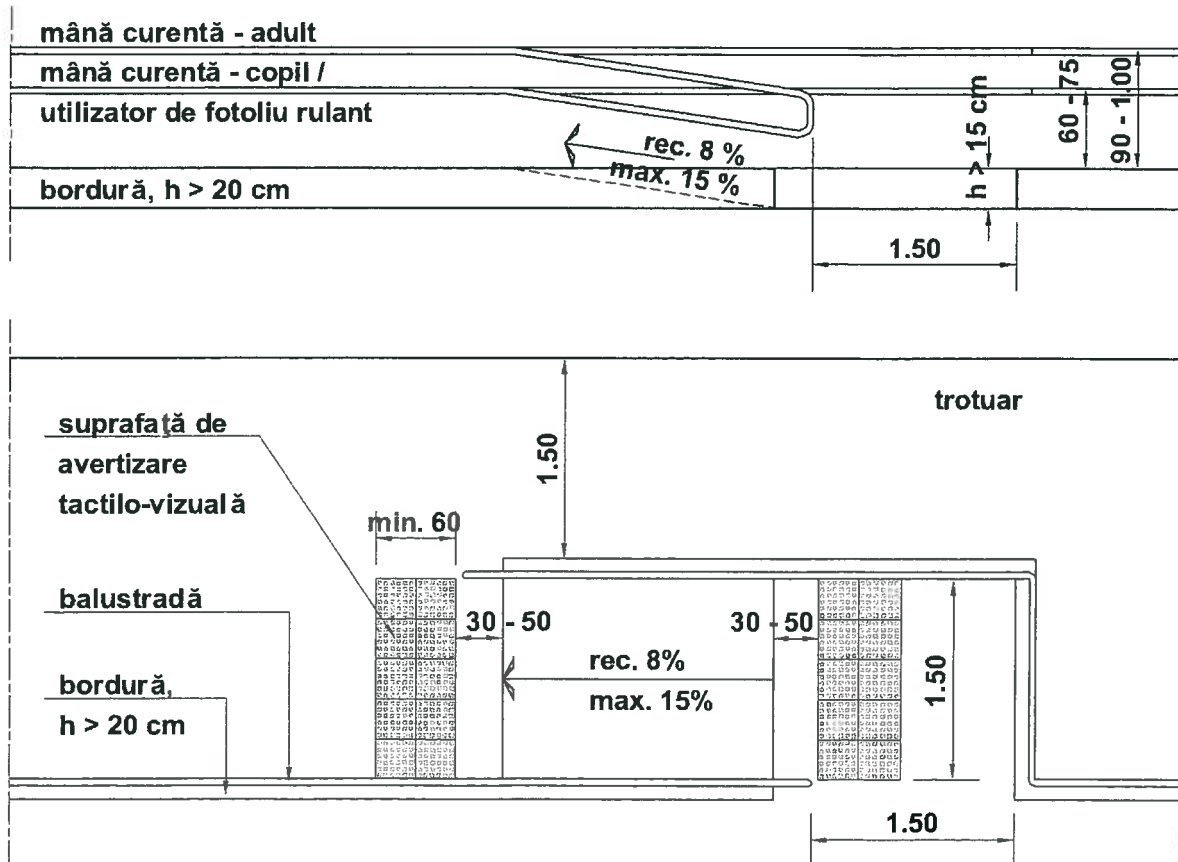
Rampă de acces pietonală între trotuar și carosabil pentru o înălțime a trotuarului de peste 20 cm
